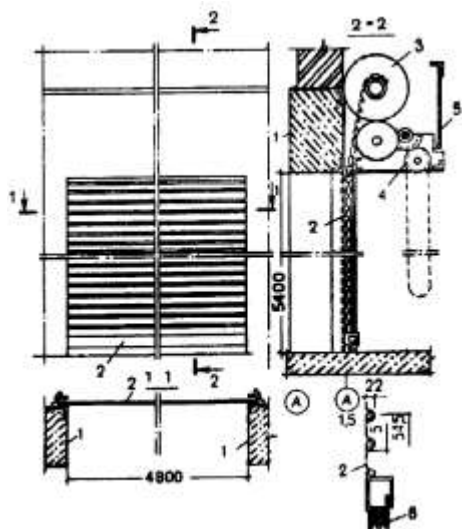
Шторні ворота: фасад, план, розріз; А - деталь штори; 1 – рама воріт; 2 - штора; 3 - барабан; 4 – ручний привод; 5 - кожух; 6 – гума
